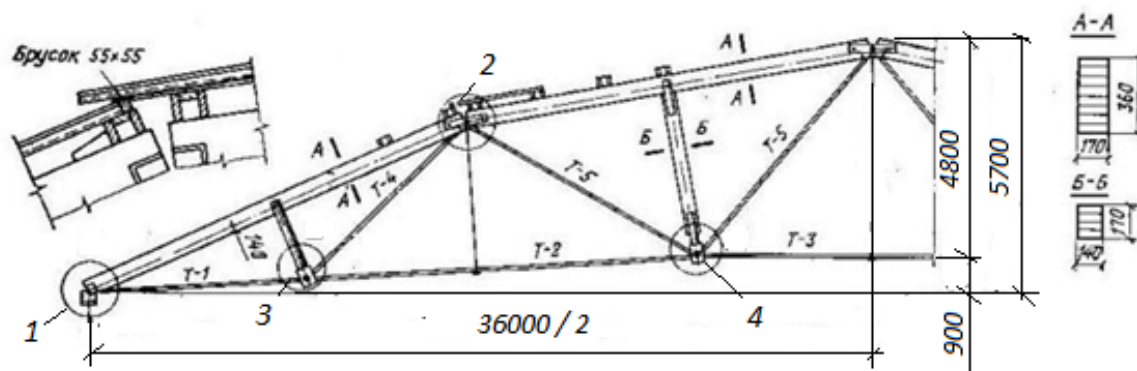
Пятиугольная ферма пролетом 35,6 м с верхним поясом из клеодощатых элементов
